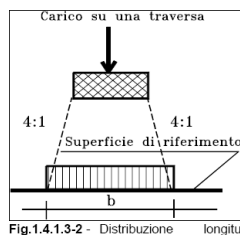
Distribuzione longitudinale dei carichi attraverso il ballast.
